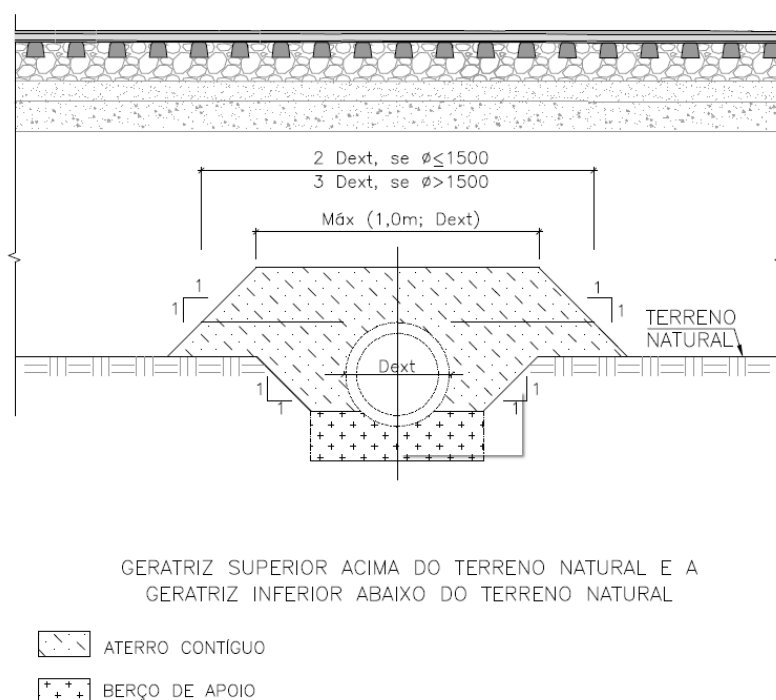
Bloco Técnico - Tipo 6 – Passagens Hidráulicas Circulares
